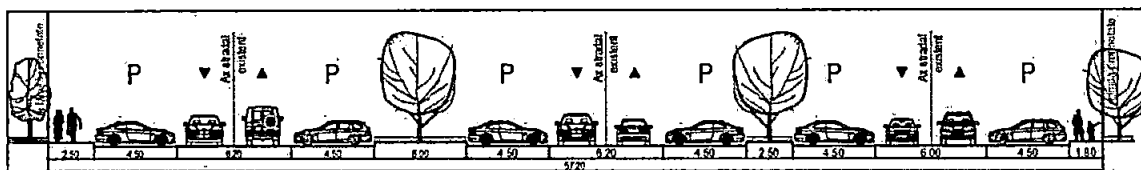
Profil stradal Aleea Daliei (efectuată transversal prin interiorul zonei reglementate).
